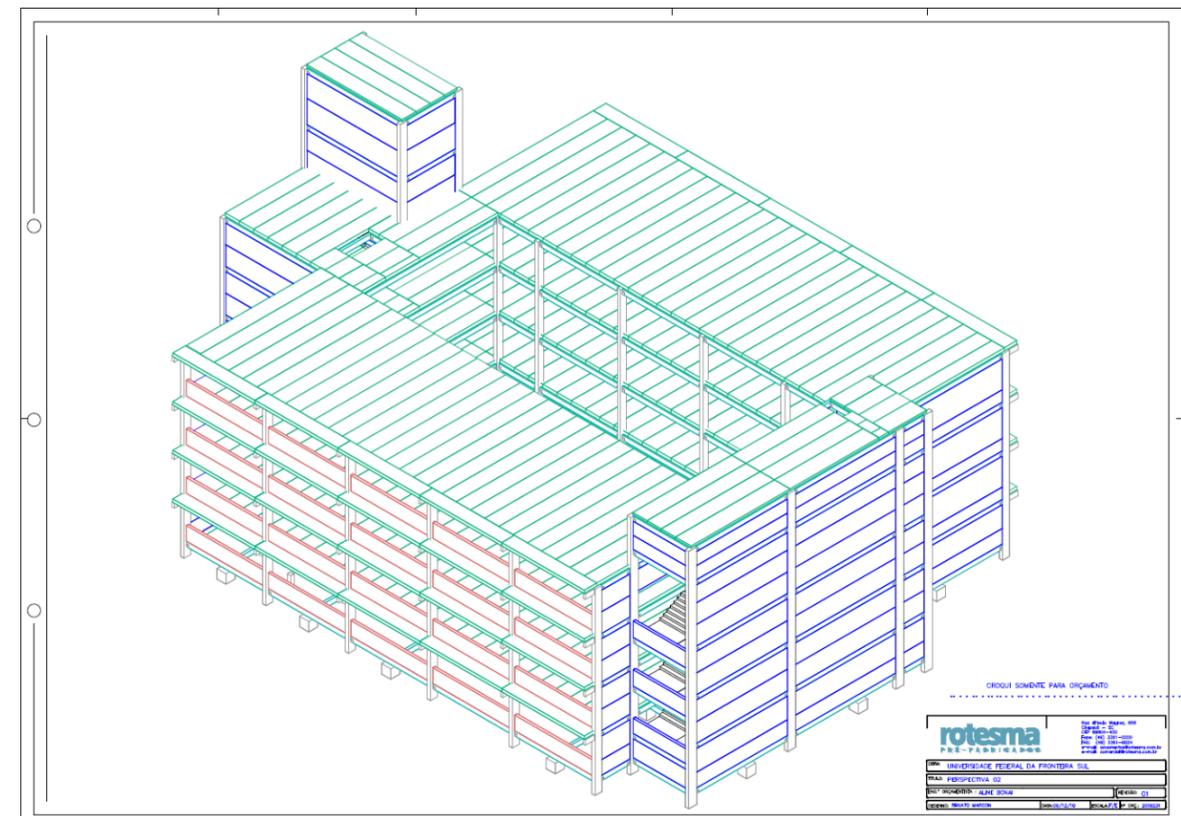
IMAGEM FACHADAS BLOCO A - CAMPUS SEDE
